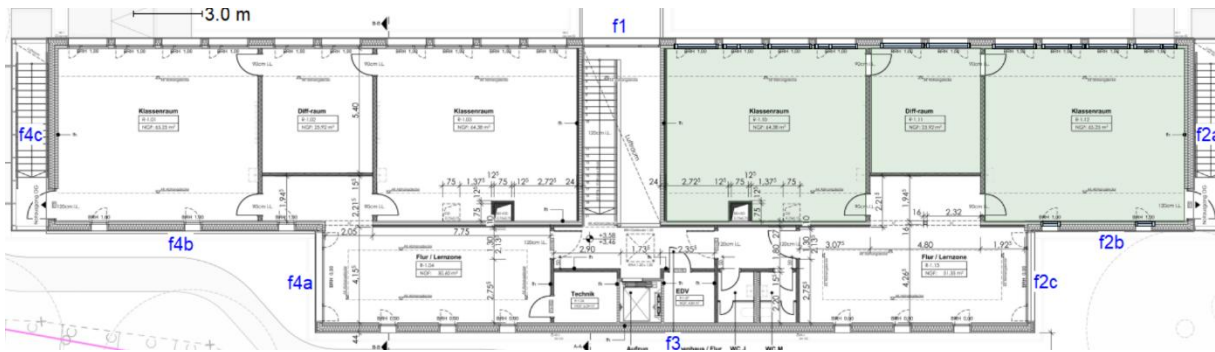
Grundriss 1. Obergeschoss
